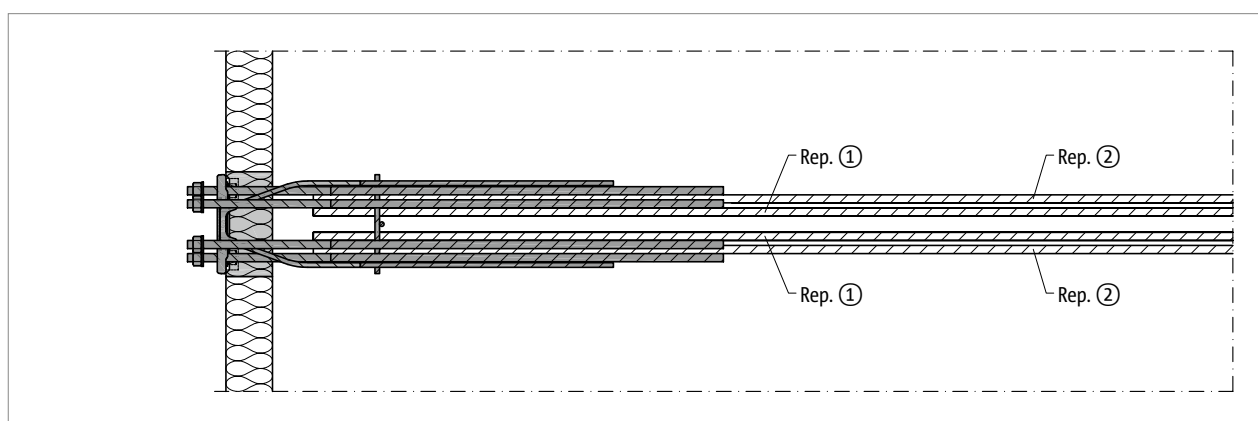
Schöck Isokorb® T type SK-MM1-VV1 : armatures à prévoir par le client, vue en plan
